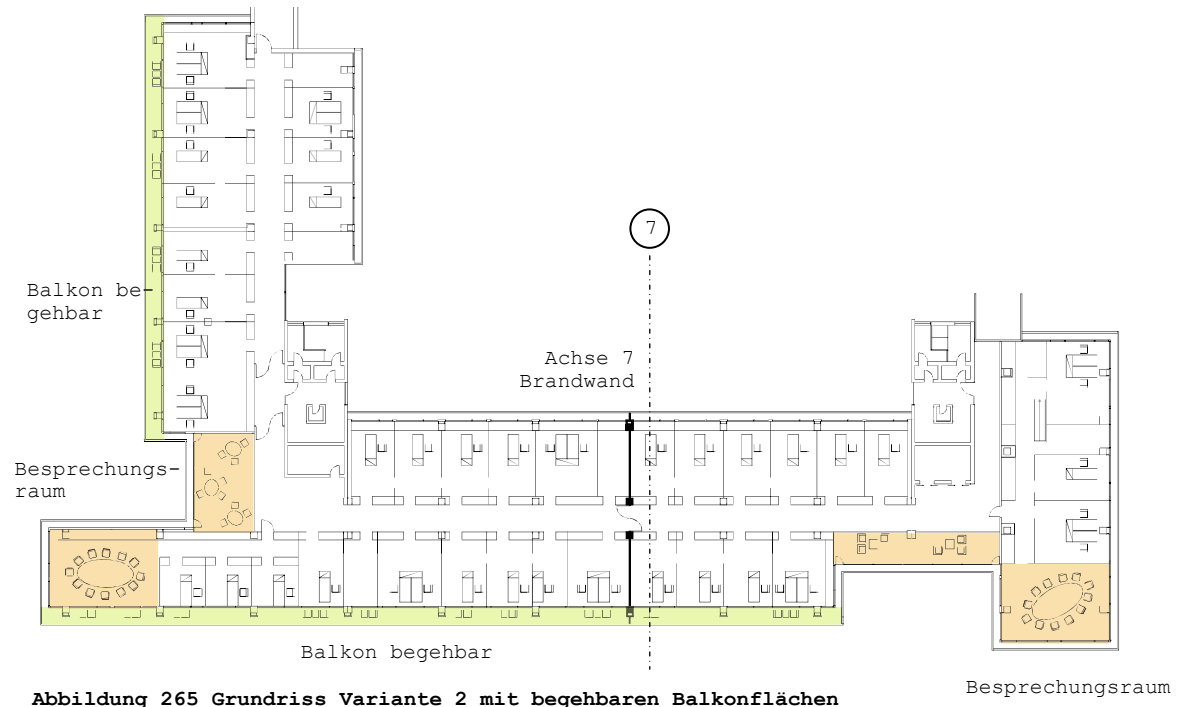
Grundriss Variante 2 mit begehbaren Balkonflächen
